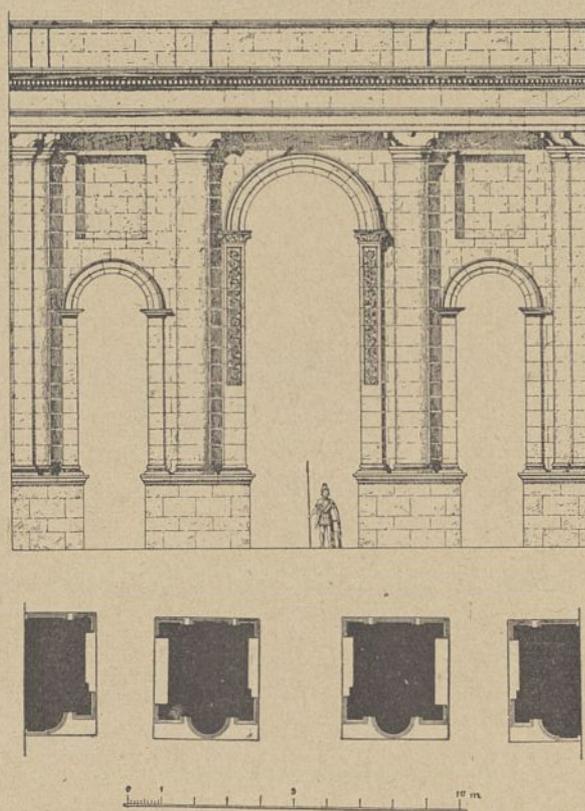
Das Straßentor. Grundriß und Aufriß.
